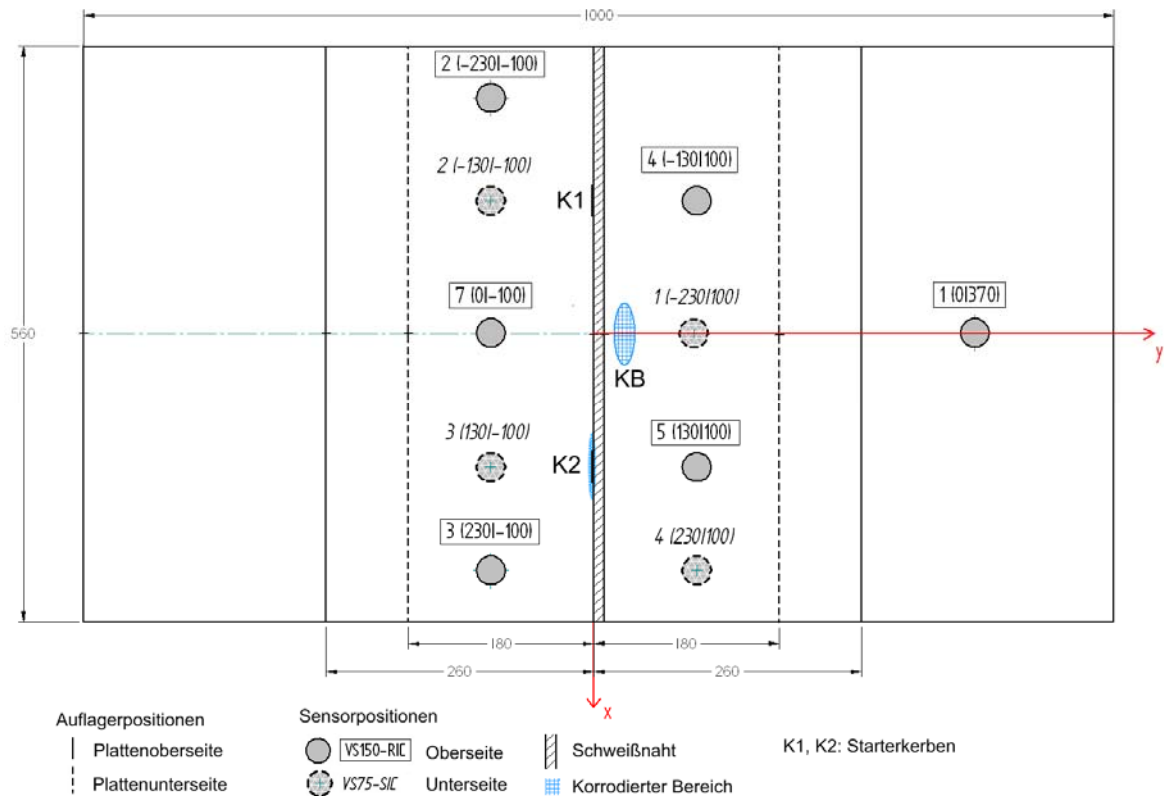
Auflager- und Sensorpositionen bei Vier-Punkt-Biegeversuchen an geschweißten Platten (alle Angaben in mm). Beispiel für die gleichzeitige Induzierung von drei Schadensmechanismen auf einer Testplatte
